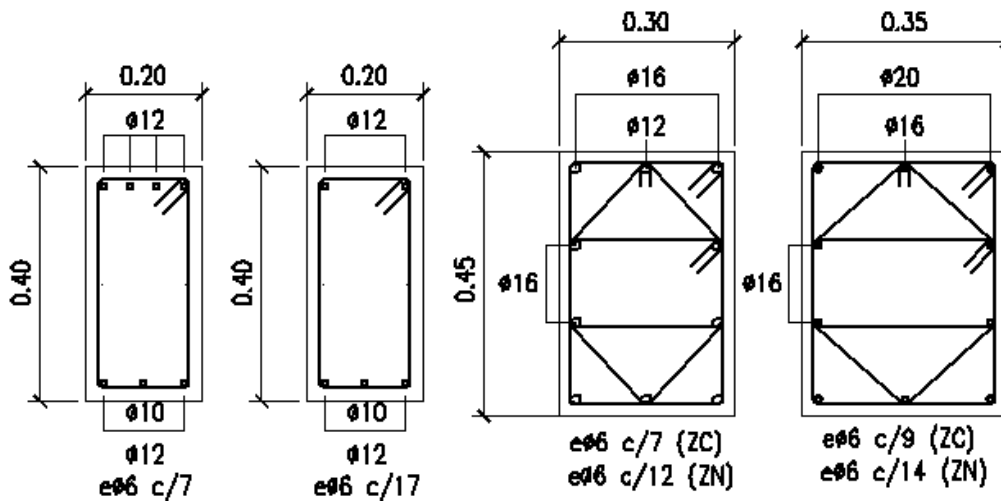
Secciones de viga V-301 y columnas C101 – C1
